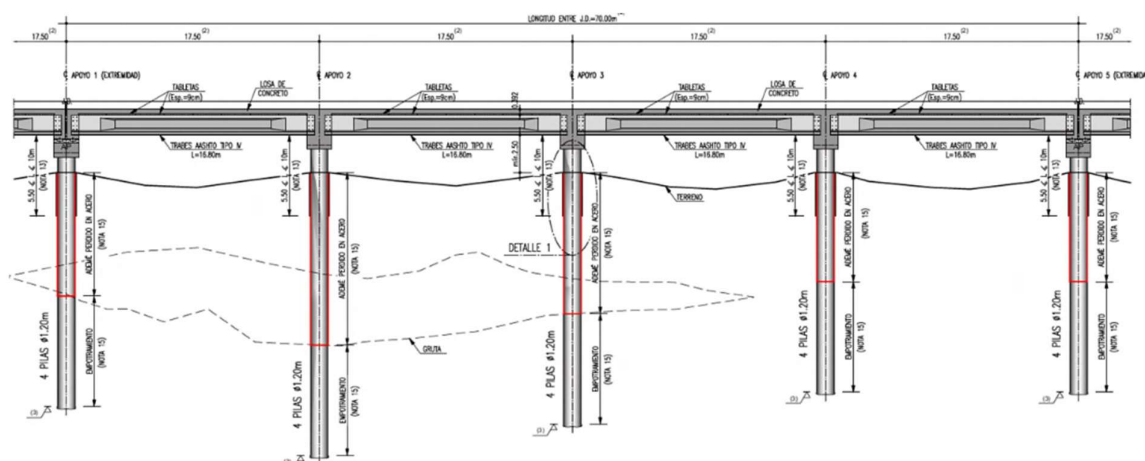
Alzado final de un módulo tipo (ejemplo subtramo C)
